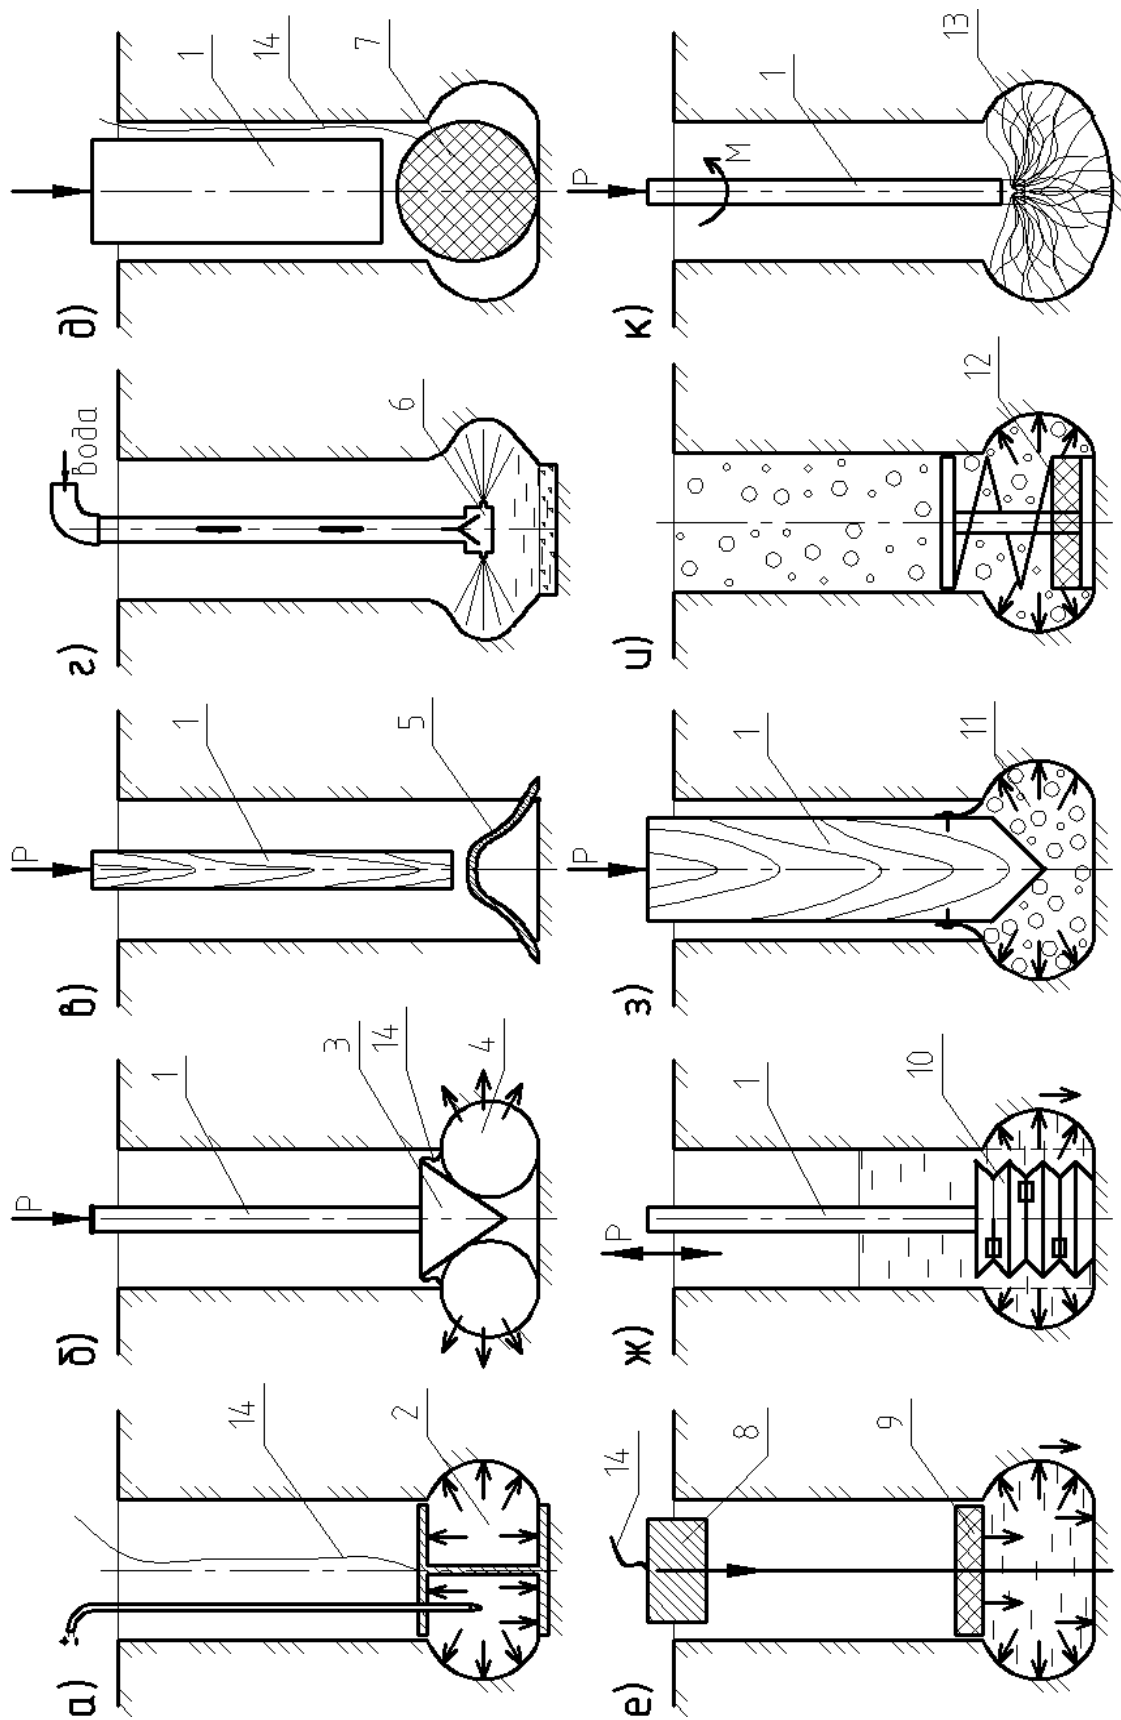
Прогрессивные конструкции устройств и приспособлений для образования уширений в забое скважин.
